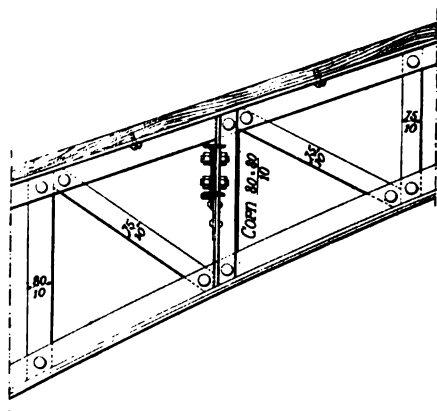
Assemblage de panne sur arbalétrier avec simple cornière.
